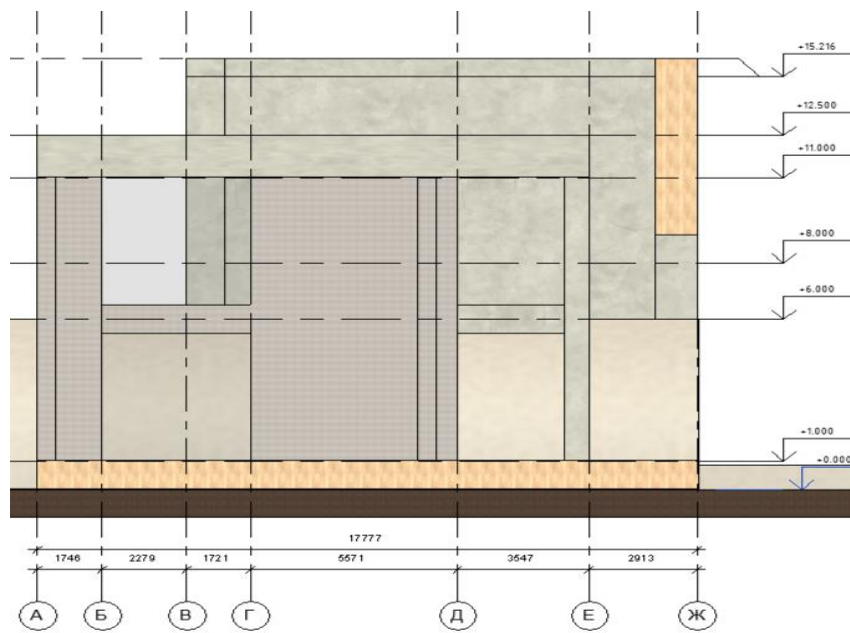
Фасад в осях А-Ж, по оси 1
